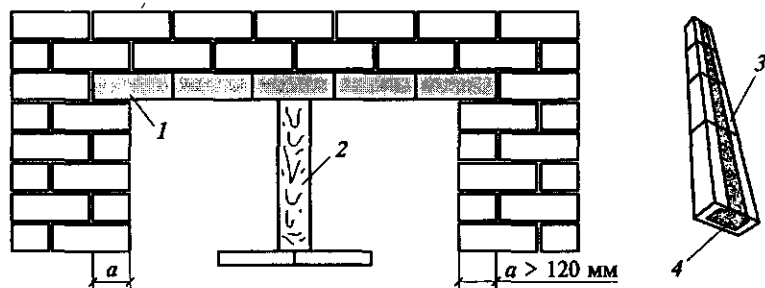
Керамобетонные перемычки над оконными и дверными проемами:
